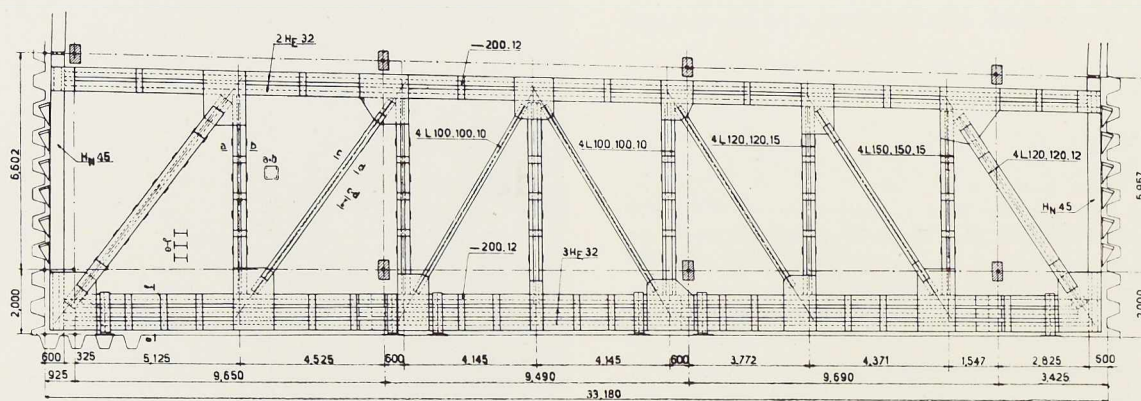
Constitution organique de la poutre Monier ayant servi à l'étaisonnement du rideau transversal de la Section 36.
